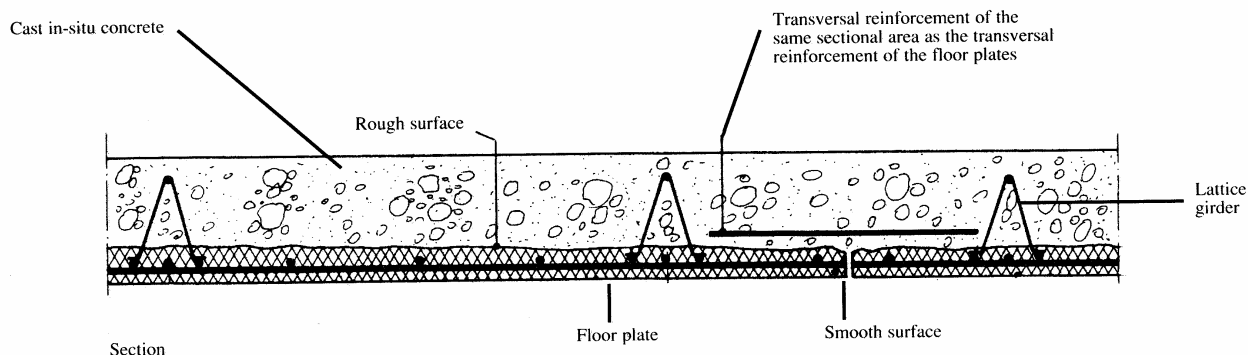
Exemplo de sistema misto para piso com painéis pré-moldados com armadura treliçada
